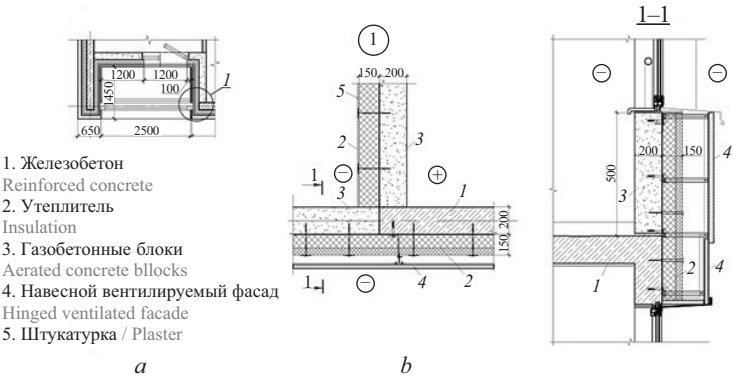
Конструктивное решение наружной стены: а — фрагмент плана здания в месте расположения лоджии; б — конструкции узлов
